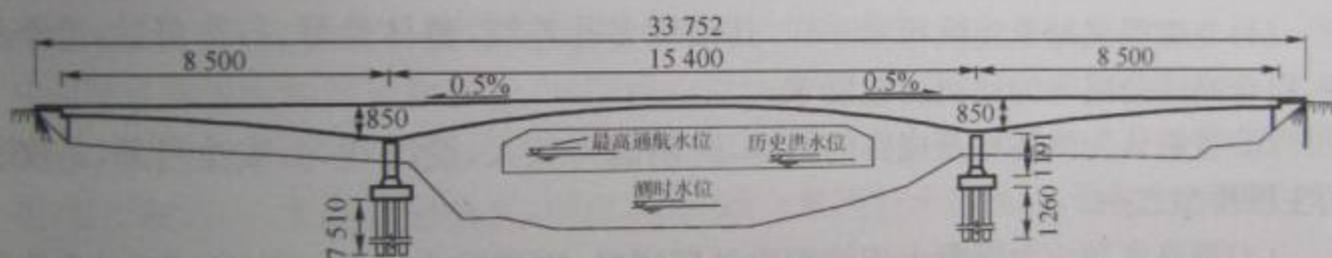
跨航道的预应力混凝土连续梁(尺寸单位:cm)
